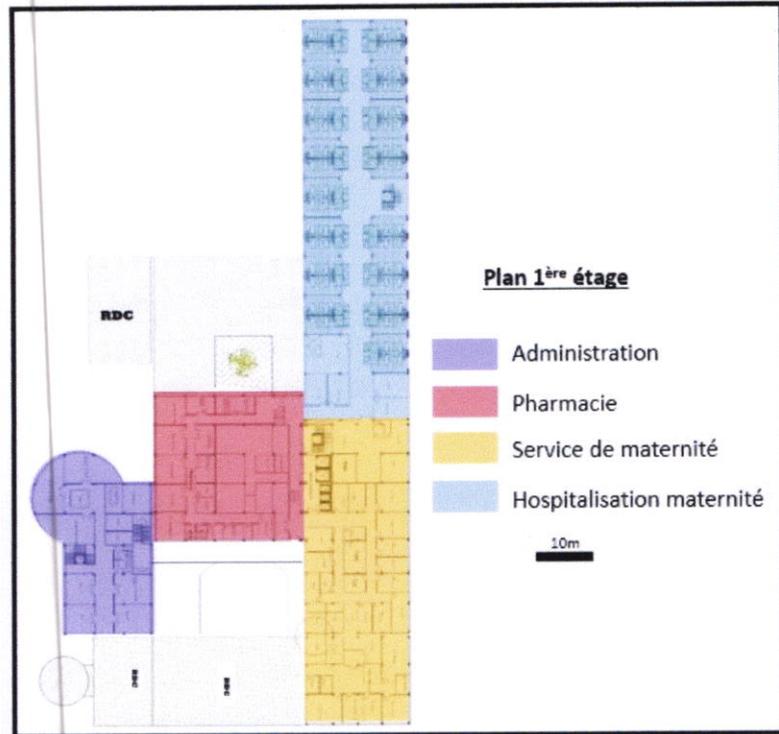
Plan 1<sup>er</sup> étage-Agencement des unités fonctionnelles Source : auteurs
